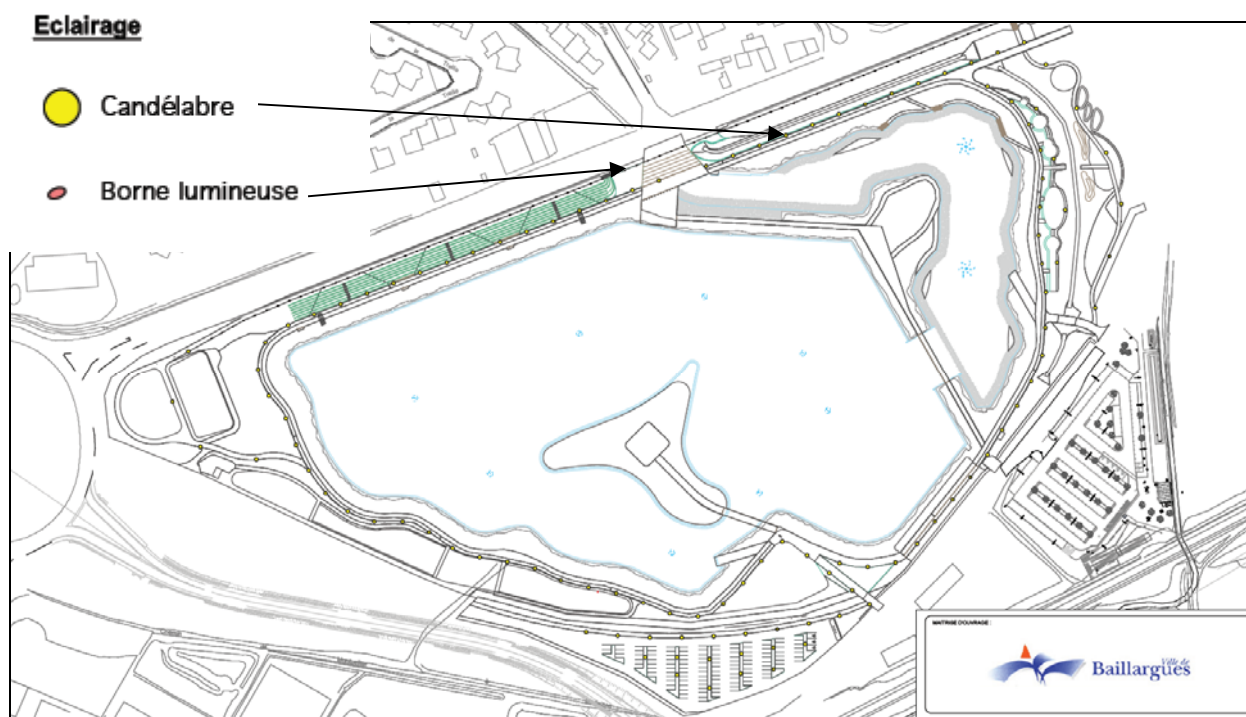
Plan d'implantation de l'éclairage (source BRL)
